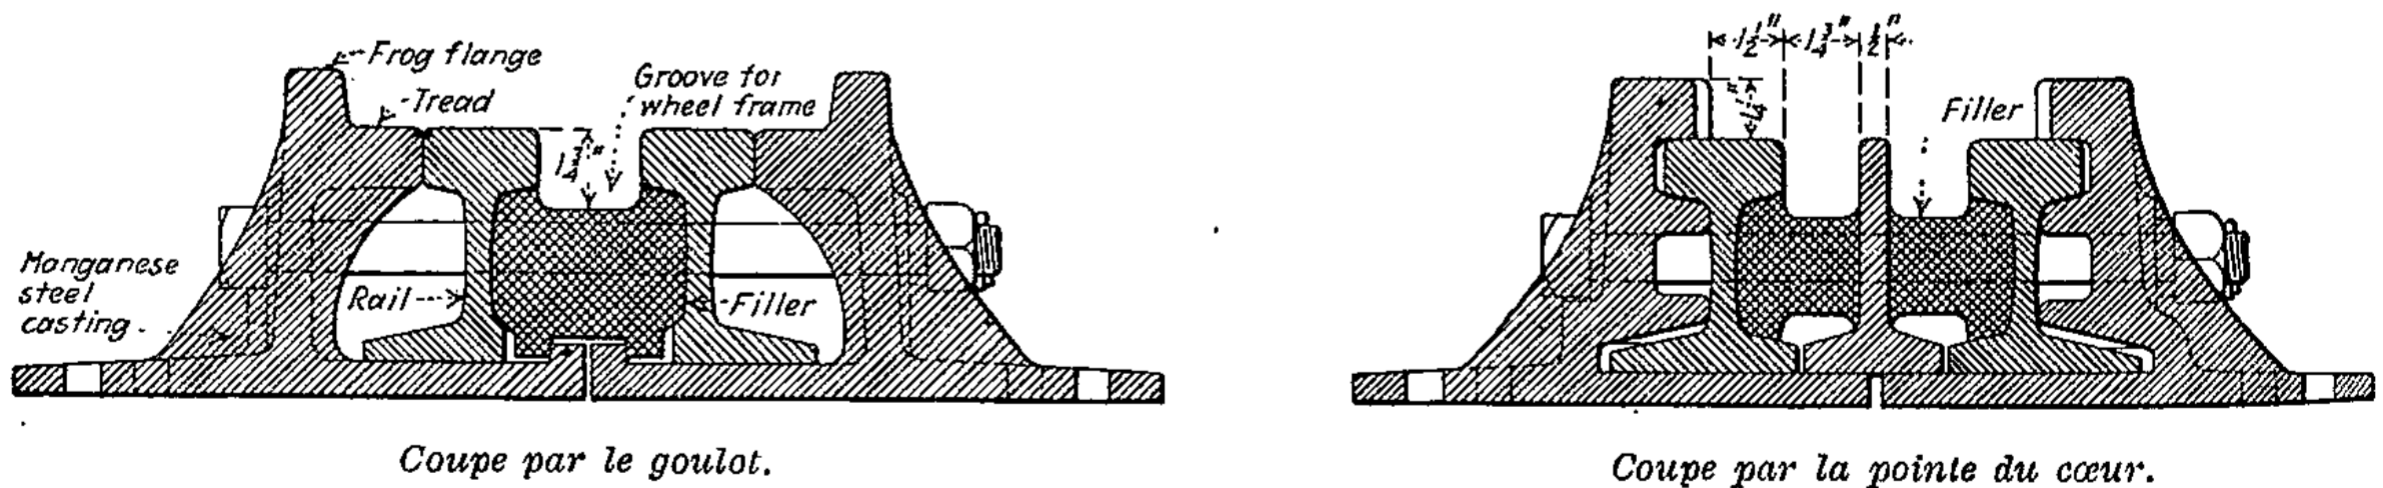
Détails du croisement à rebords assemblé de pièces.
